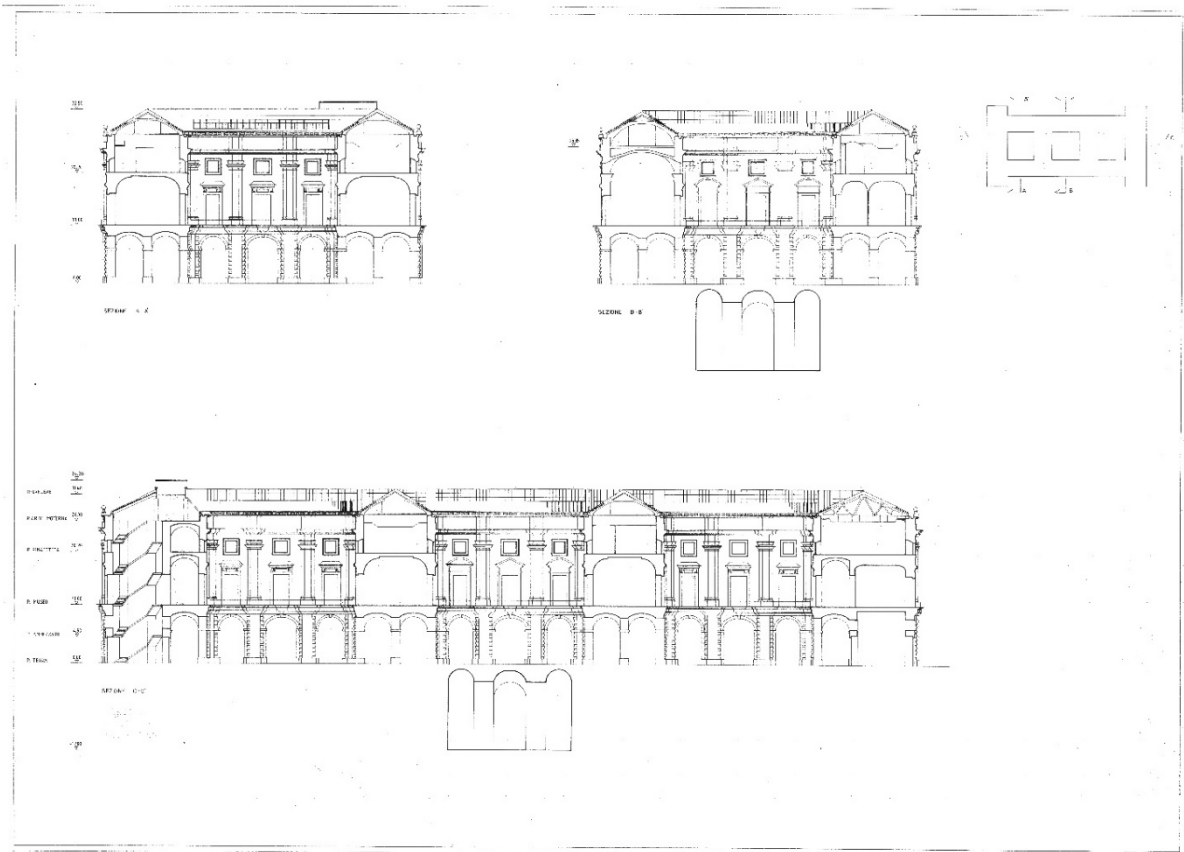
Sezioni di progetto, 1952-54, Archivio della Fondazione E.B. De Felice
